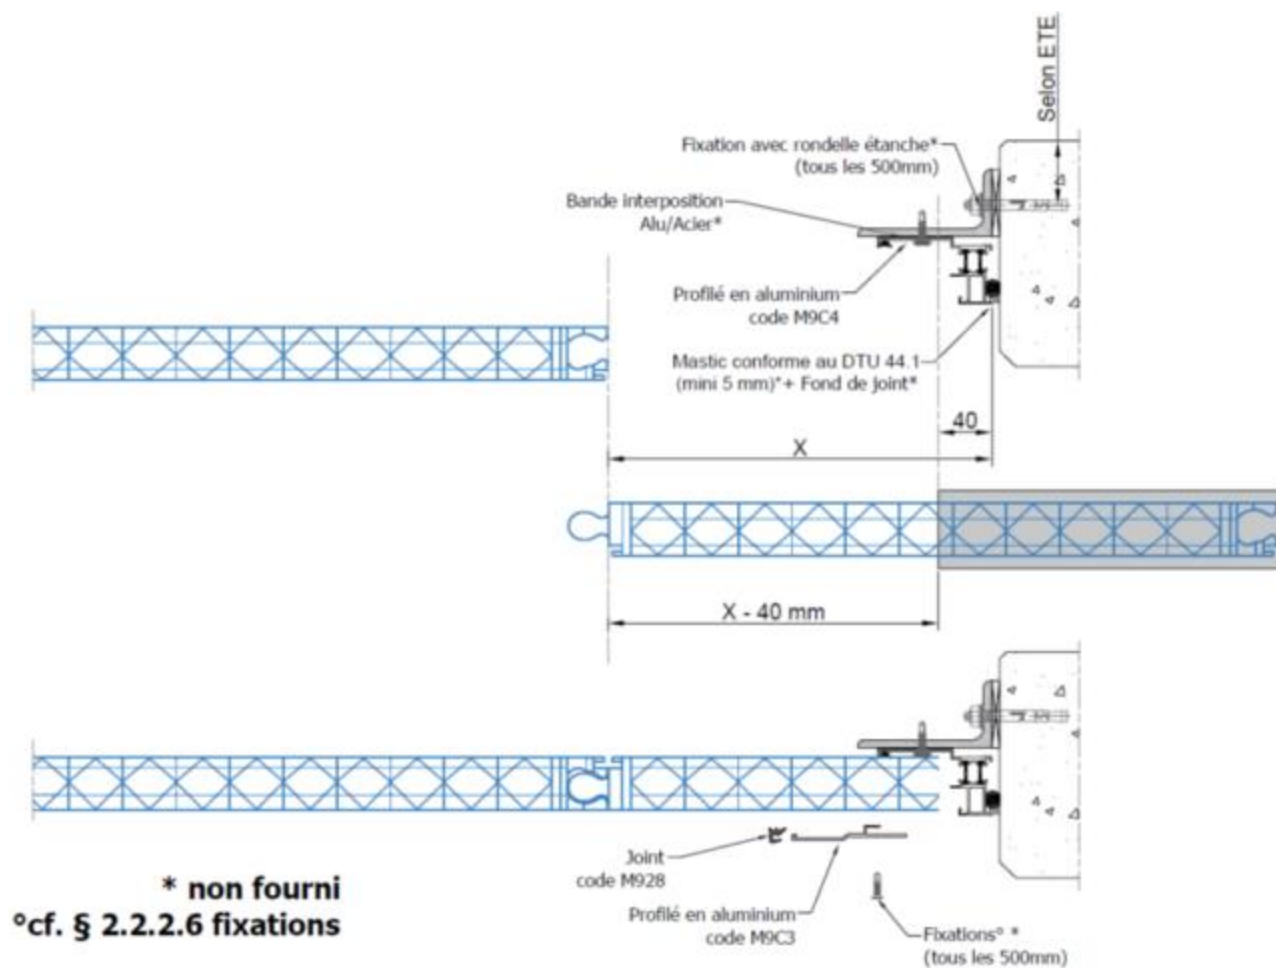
Profilés à rupture de pont thermique - Montage du dernier panneau
